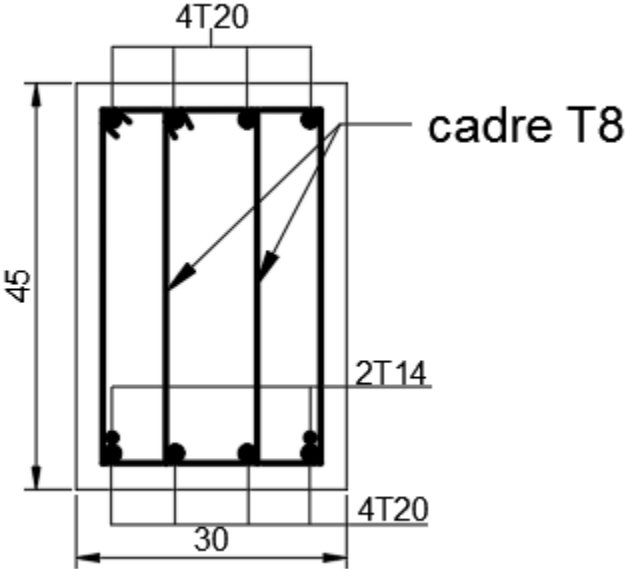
Ferrailage des poutres porteuses sur travée
